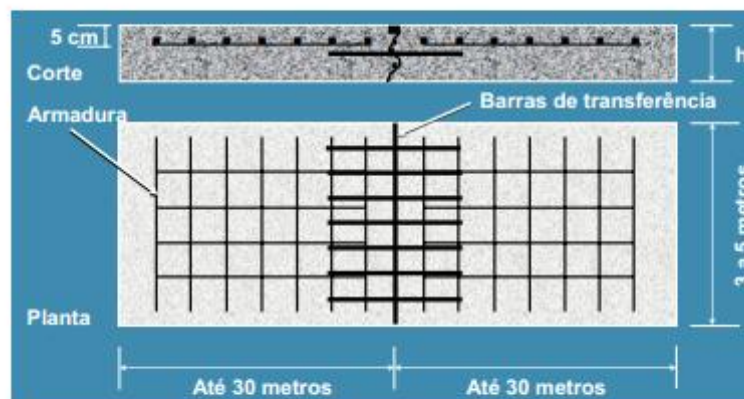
Pavimento de Concreto Com Armadura Distribuída Descontínua Sem Função Estrutural
